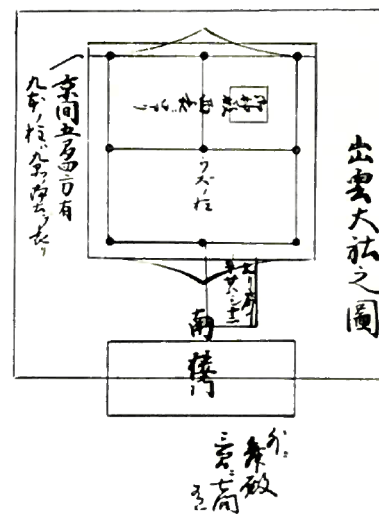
Plano Shomei; planta del *honden* del Santuario de Izumo en la reconstrucción de 1609.
